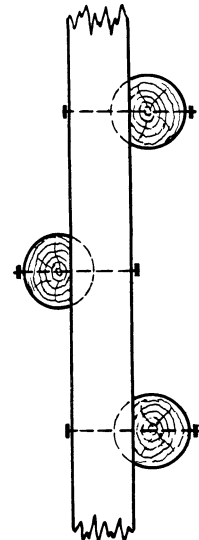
Verbindung der Grundjochschwelle mit den Pfählen.
